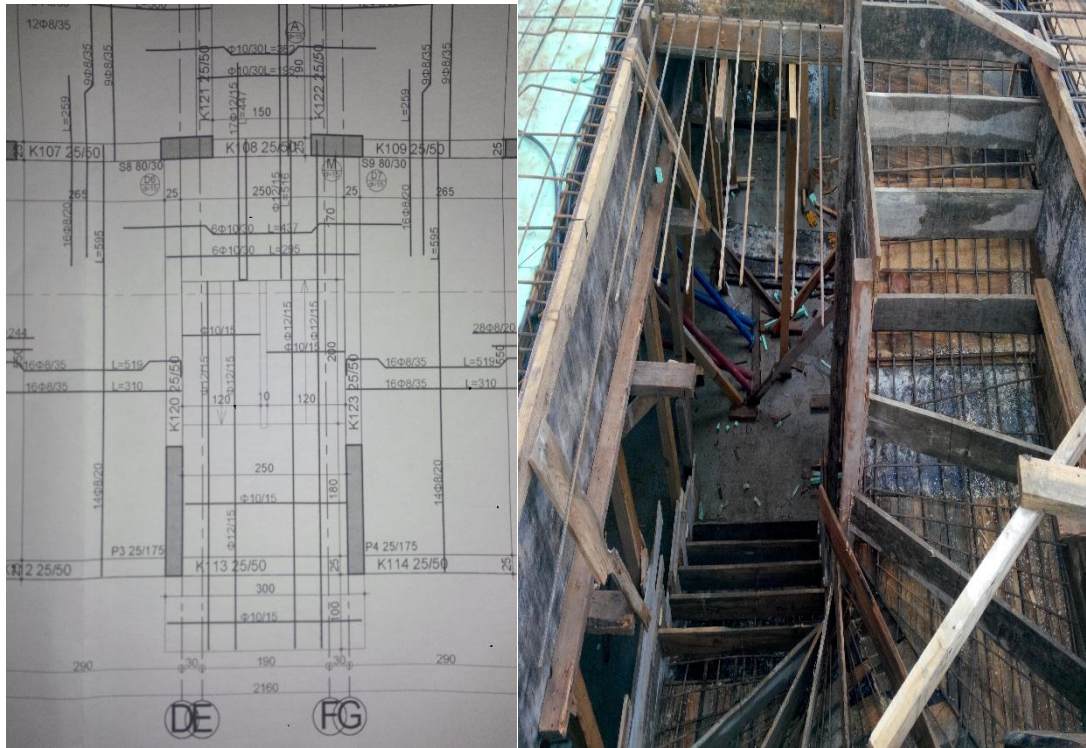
Kirişli radye temelerde net beton örtüsü şartına uyulmaması durumu
